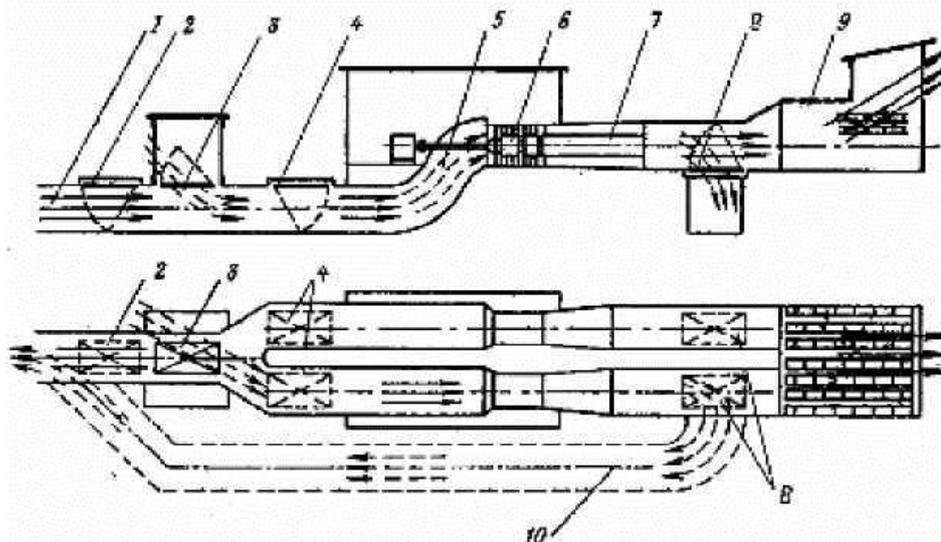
Схема вентиляторной установки с нереверсивным вентилятором ВОКД-3: 1 - подводящий канал; 2 - отсекающая лядя канала; 3 - лядя всасывающей будки; ляди переключения; 5 - утка; 6 - вентилятор; 7 - диффузор; 8 - ляди диффузоров; 9 - глушитель шума; 10 - обводной канал
